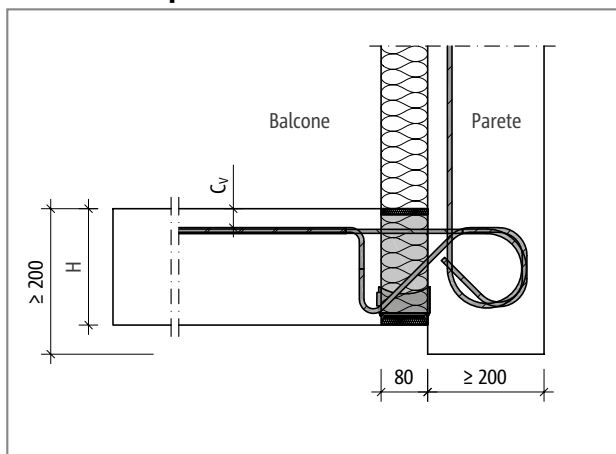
Schöck Isokorb® T tipo KL-WO: raccordo alla parete verso l'alto con isolamento esterno
